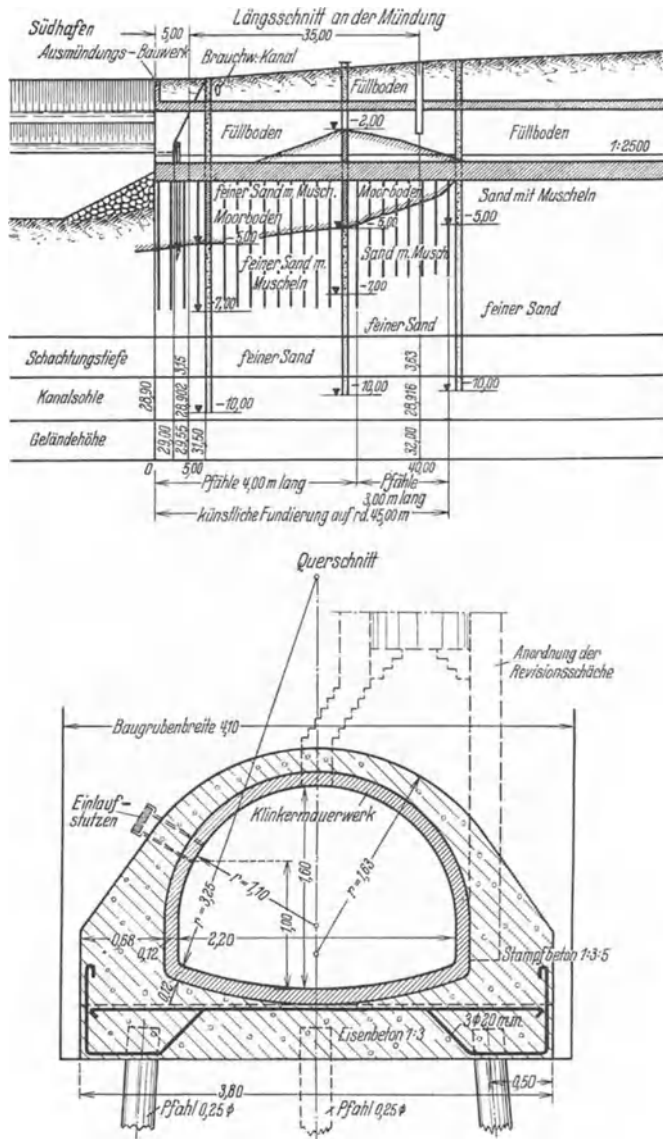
Pfahlgründung mit Eisenbetonrost (nach Hahn und Langbein).
